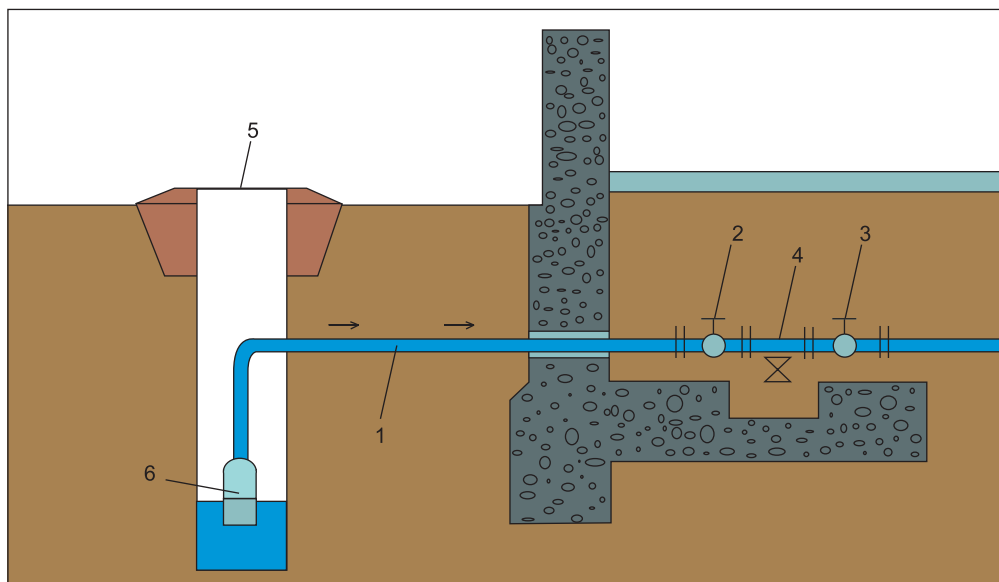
Схема прокладки водопровода сквозь фундамент: 1 — ввод, диаметр трубы не менее 50 мм; 2 — первый вентиль; 3 — второй вентиль; 4 — спускной кран; 5 — колодець; 6 — насос
